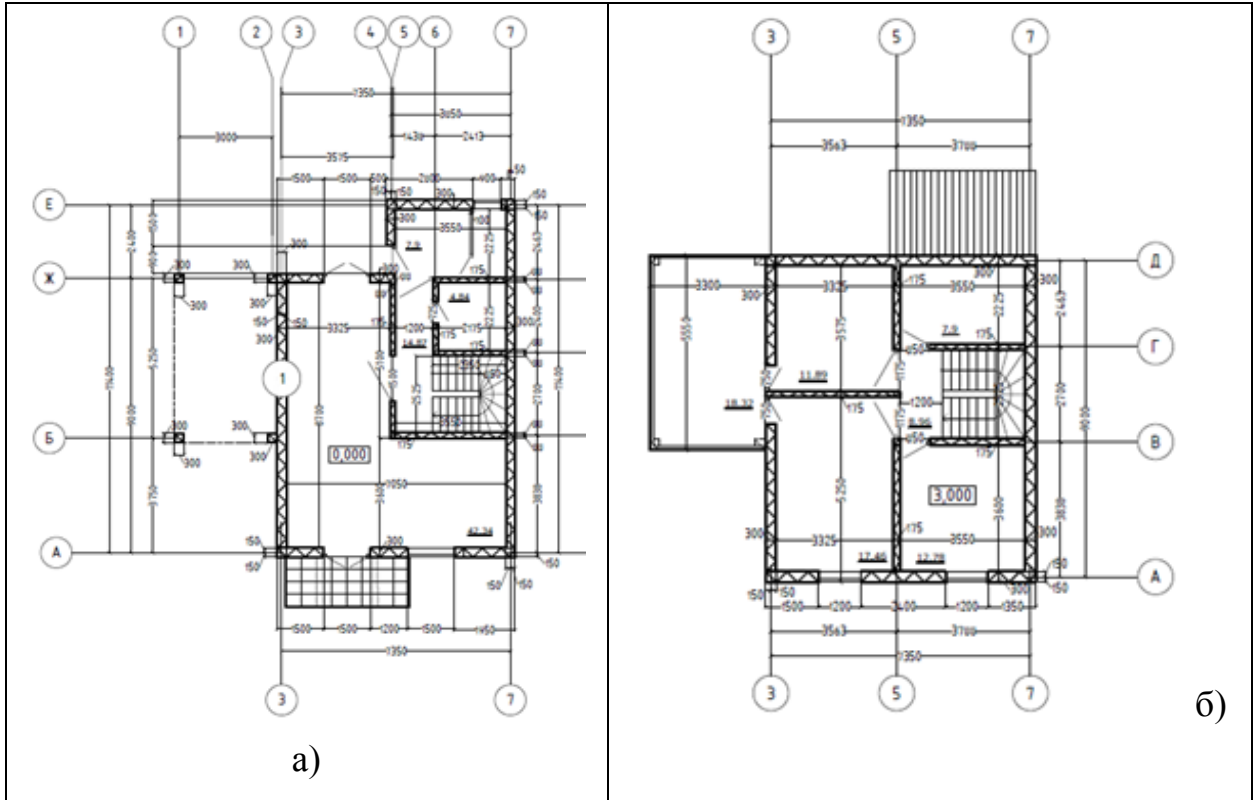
Плани поверхів будівлі: а) першого, б) другого.
